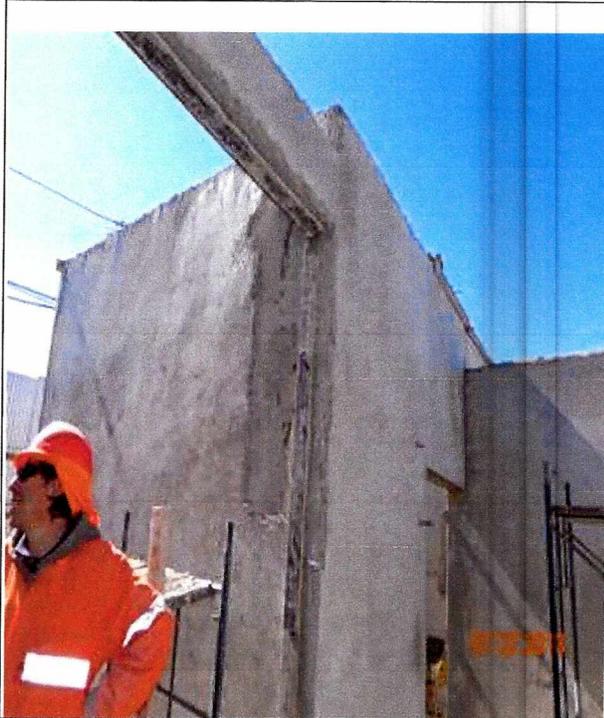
Intervención en muro de vivienda bloque C.
